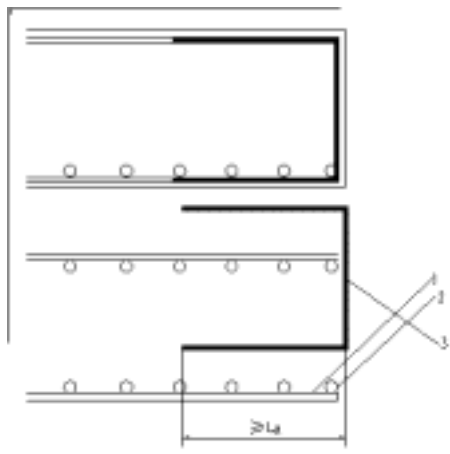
2 钢筋焊接网在墙体端部（无暗柱）的构造图
